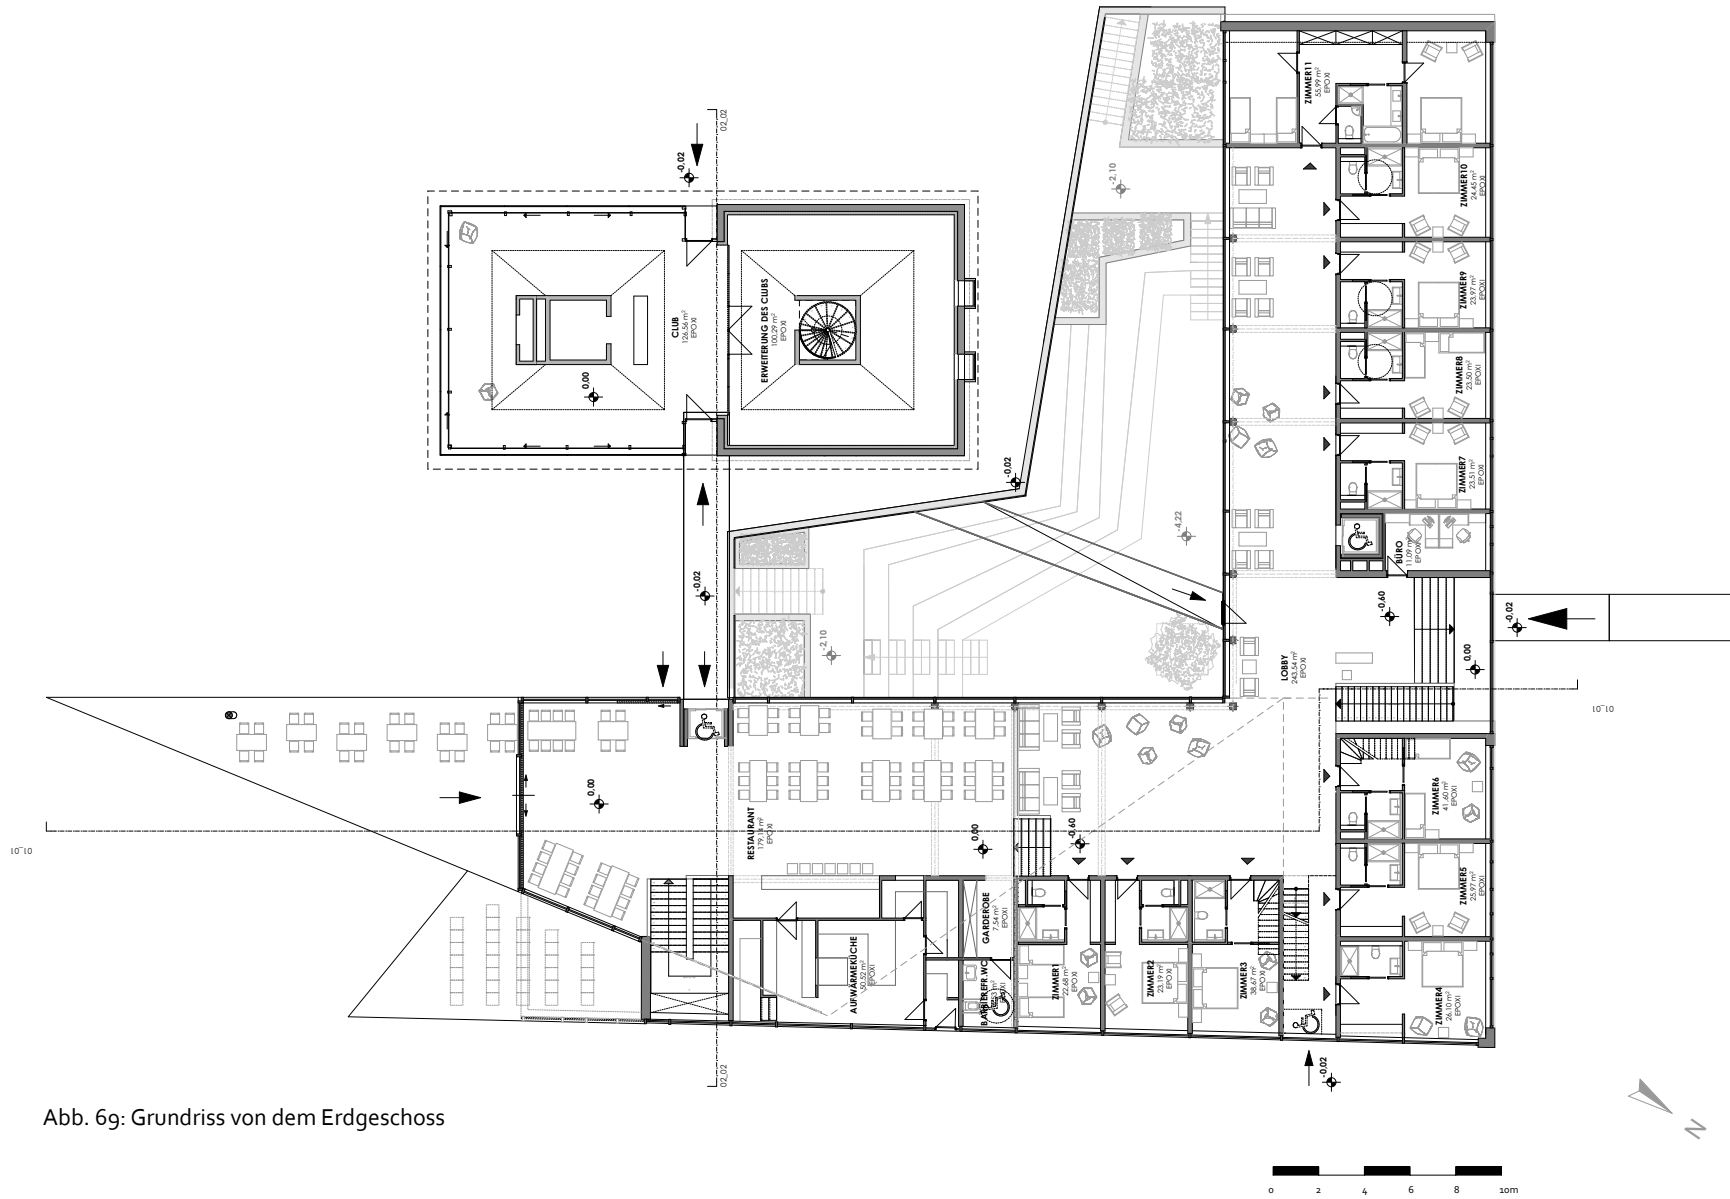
Grundriss von dem Erdgeschoss
